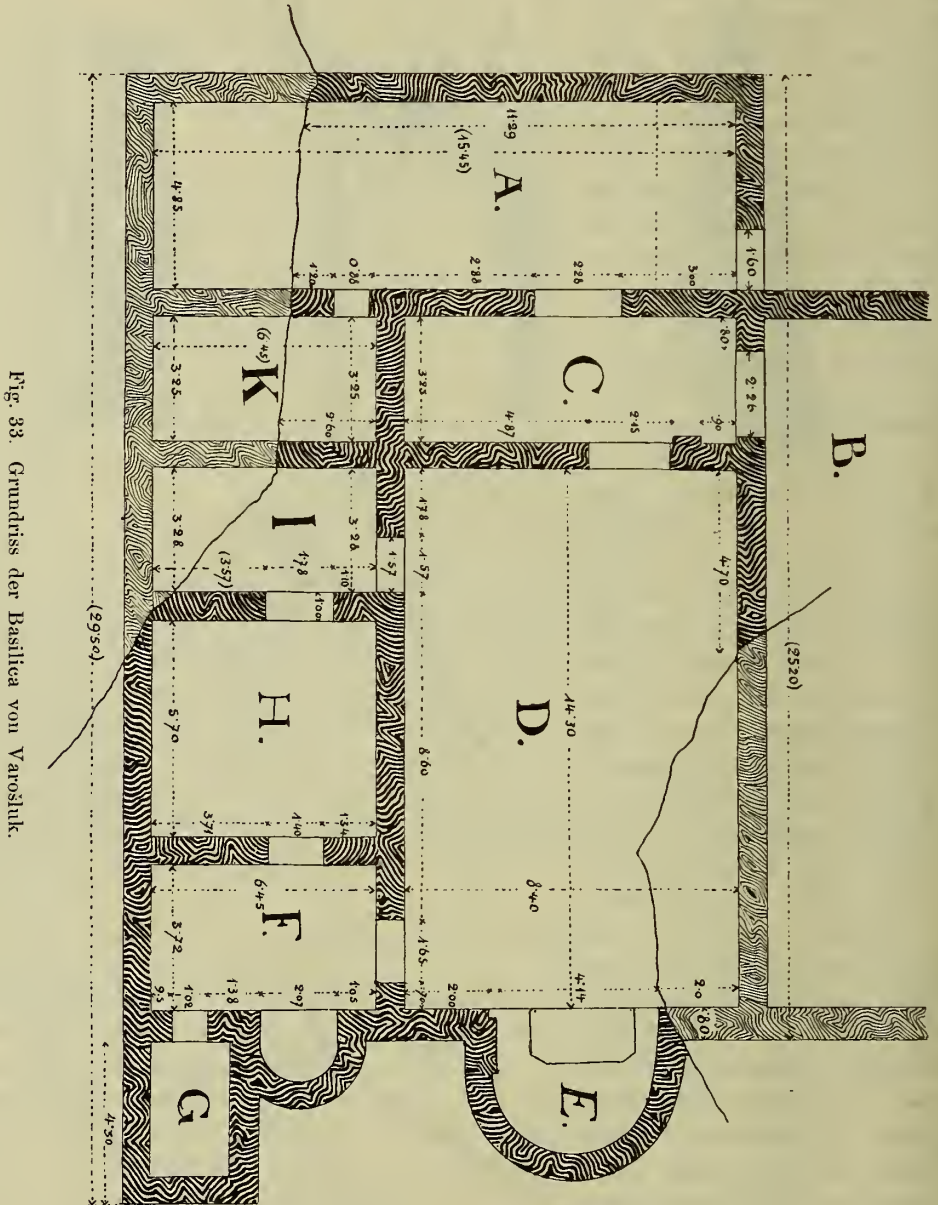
Grundriss der Basilica von Varosluk.
